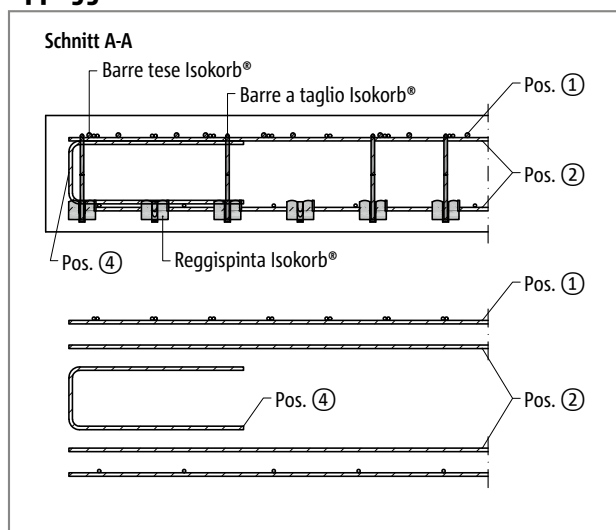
Schöck Isokorb® XT tipo KL: armatura in opera, lato balcone, in sezione A-A; Pos. 4 = bordura costruttiva sul bordo libero
